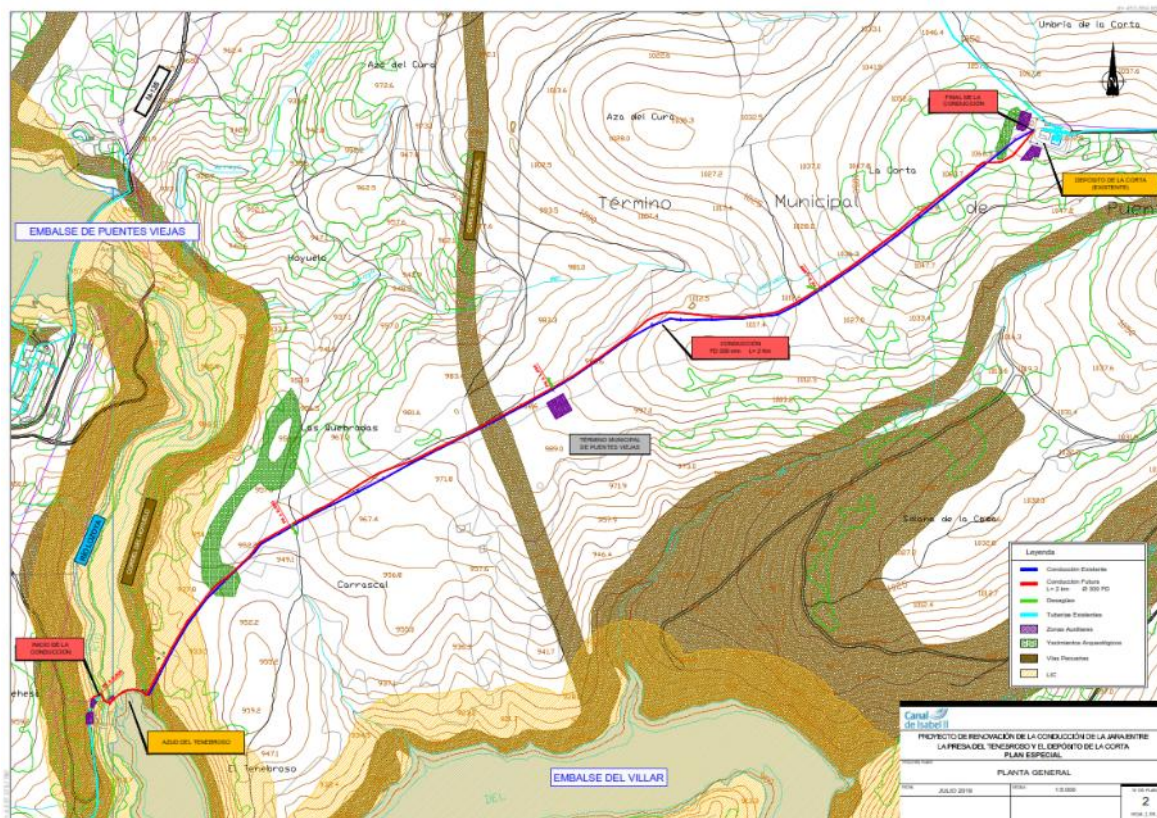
Plano general de renovación de la conducción de la Jara entre la presa del Tenebroso y el depósito de la Corta. Fuente: Plan Especial.
